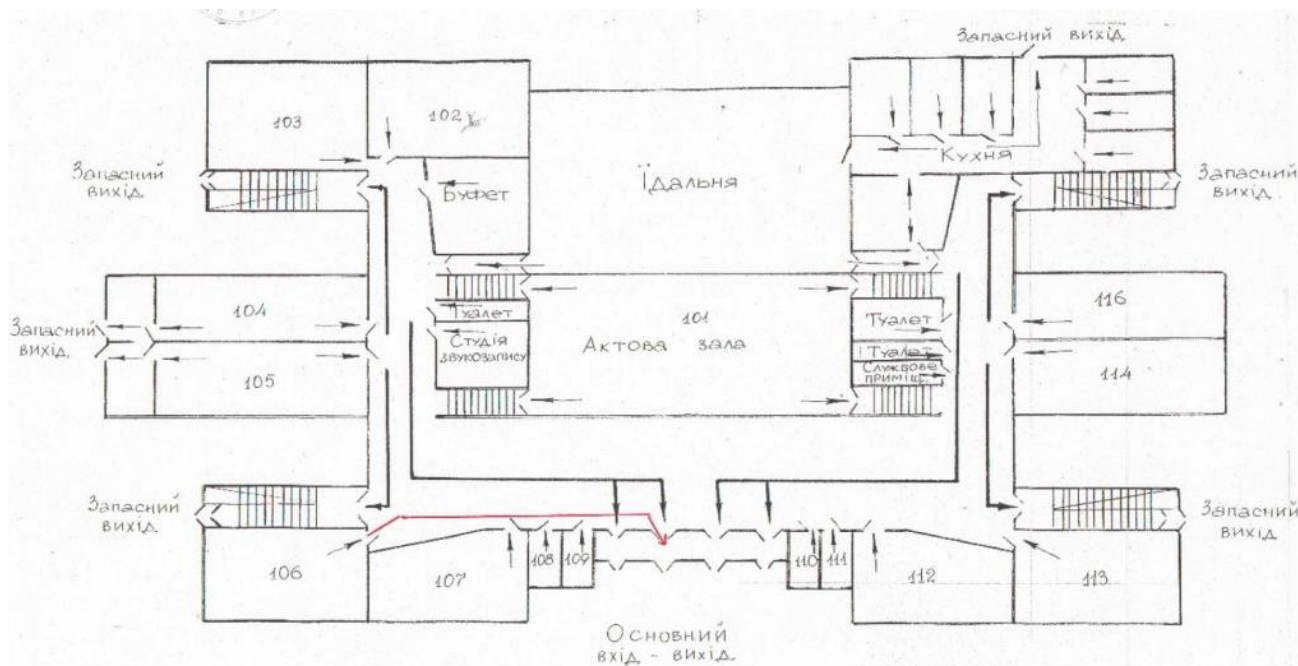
Схематичний план 1 поверху з різними типами приміщень
